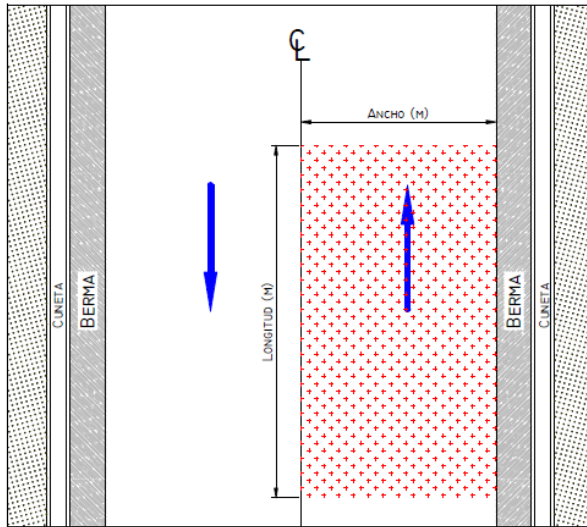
Cabezas duras sobre pavimento asfáltico existente.
